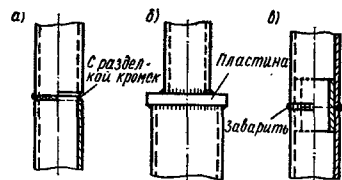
Заводские сварные стыки (а—в) трубчатых колонн
